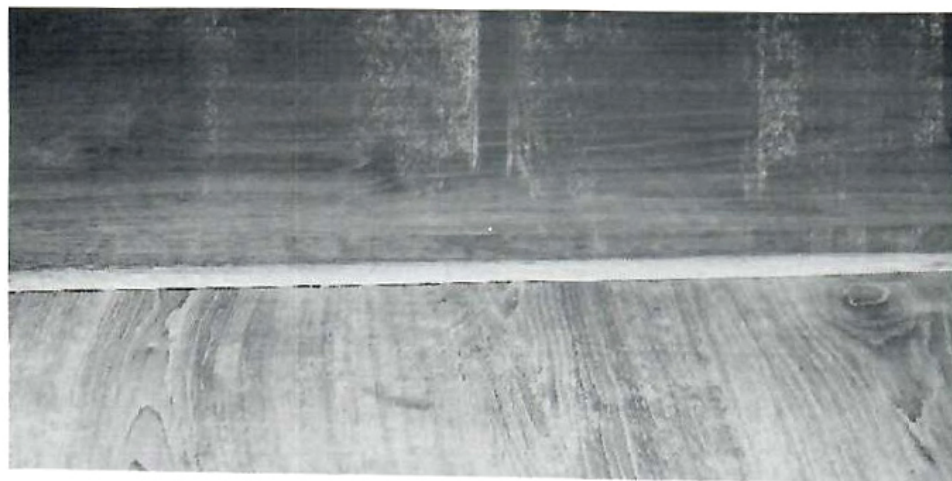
Тот же участок полового покрытия (дверной проем из комнаты
